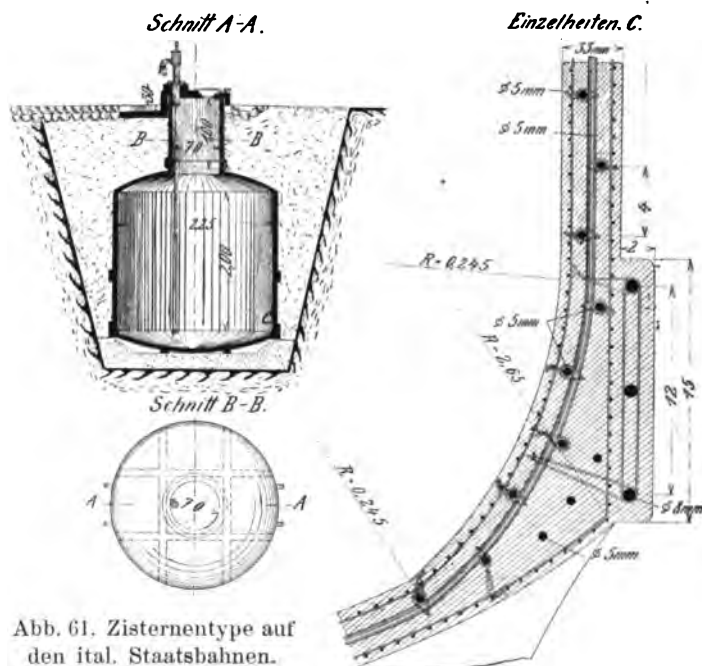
Zisternentype auf den ital. Staatsbahnen.
